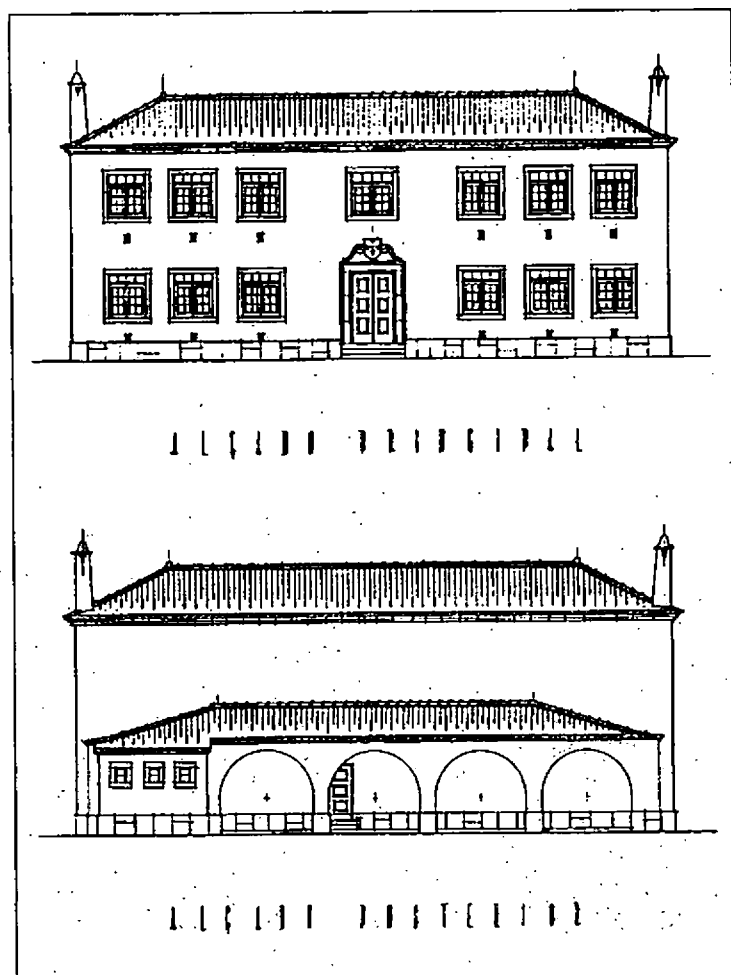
Alçado do edifício da escola da Pena construído à cota menos elevada⁷⁶.
